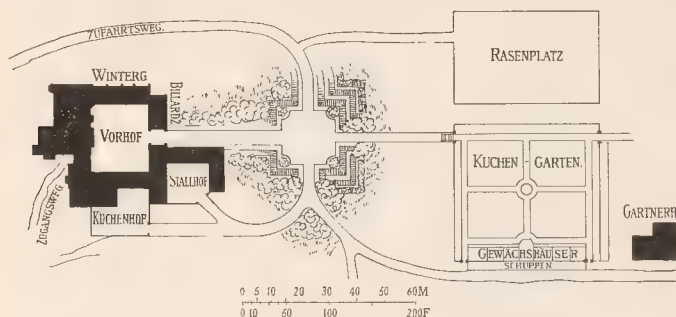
Lageplan des Landhauses Lyes Wood, Sussex. Erbaut 1868 von R. Norman Shaw.
